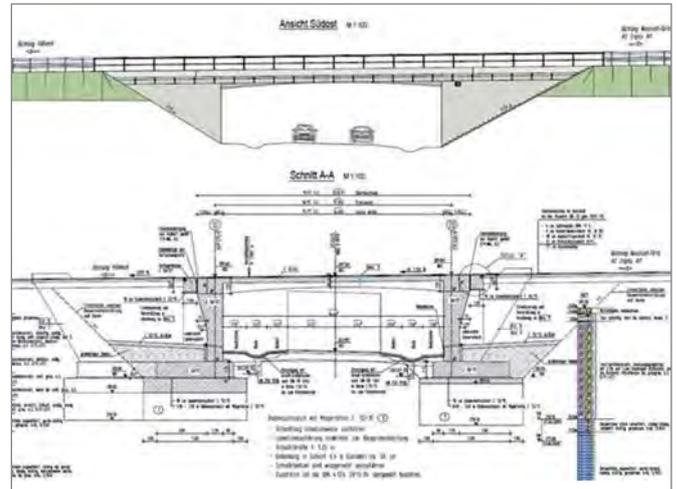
Ansicht und Längsschnitt Brückenentwurf Bw 1
